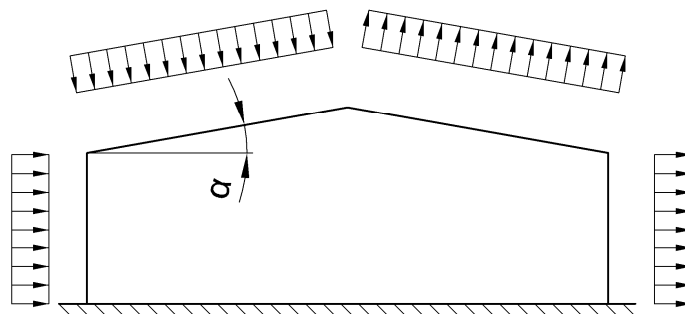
Ветровая нагрузка на здания с двухскатными покрытиями
